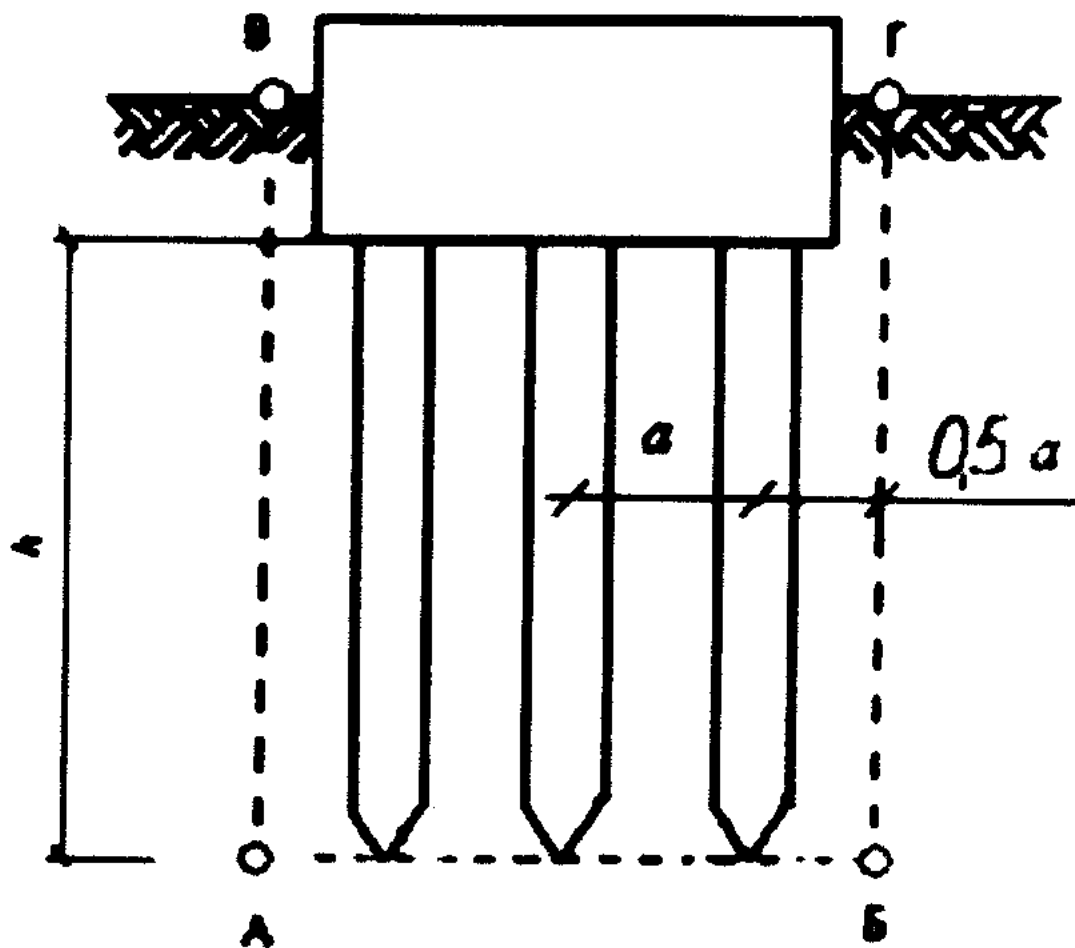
Определение границ условного фундамента при расчете свайных фундаментов [25]
